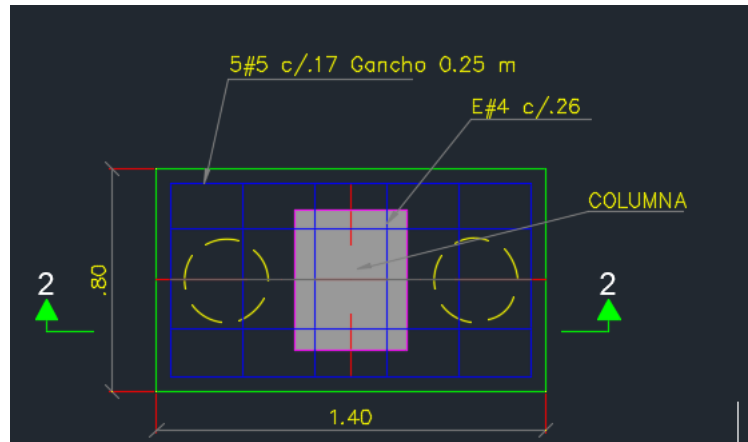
Ilustración de refuerzo planta cabezal tipo 3 (CB-3)
